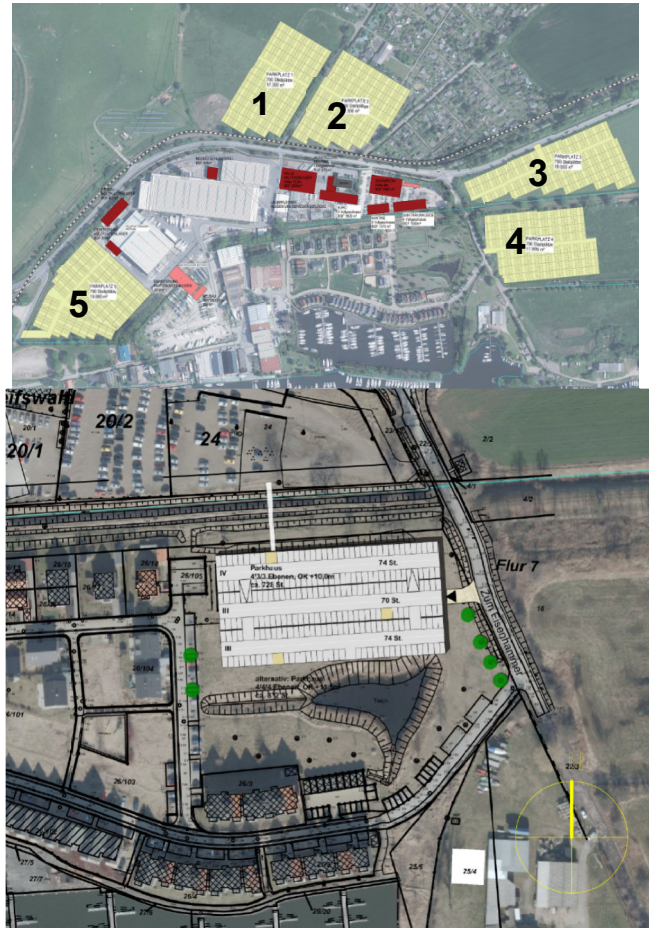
Standort 6 als Parkhaus mit 4 Ebenen (Quelle: stadtplanung und architektur)
